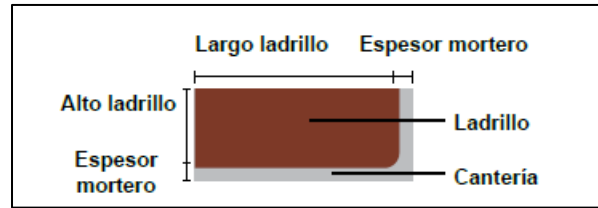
Vista sección ladrillo y cantería, elaboración propia.
